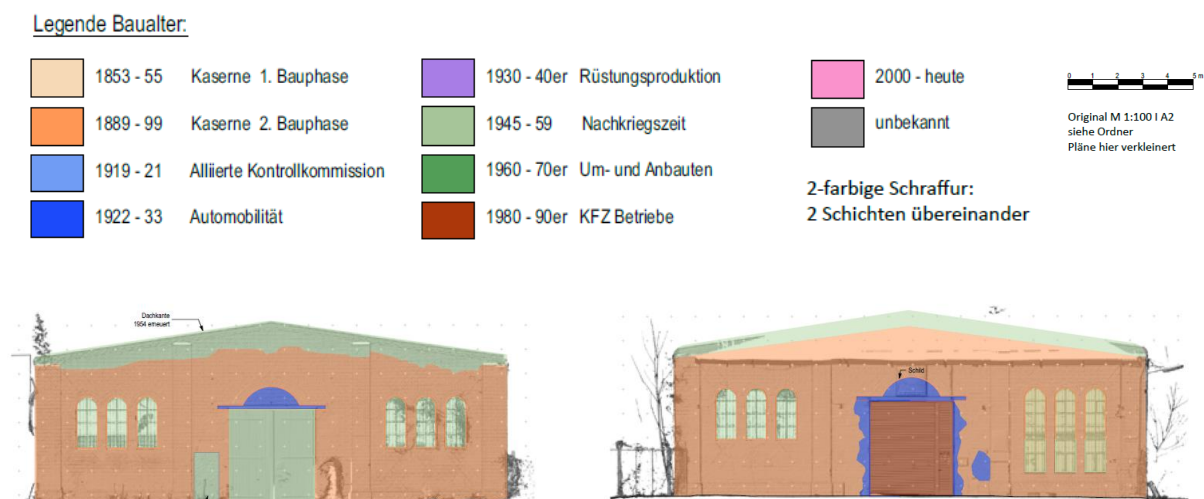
Neue Reithalle, Giebelansichten mit Kartierung der Bauepochen (Auszug Denkmalpflegeplan, 2020)
